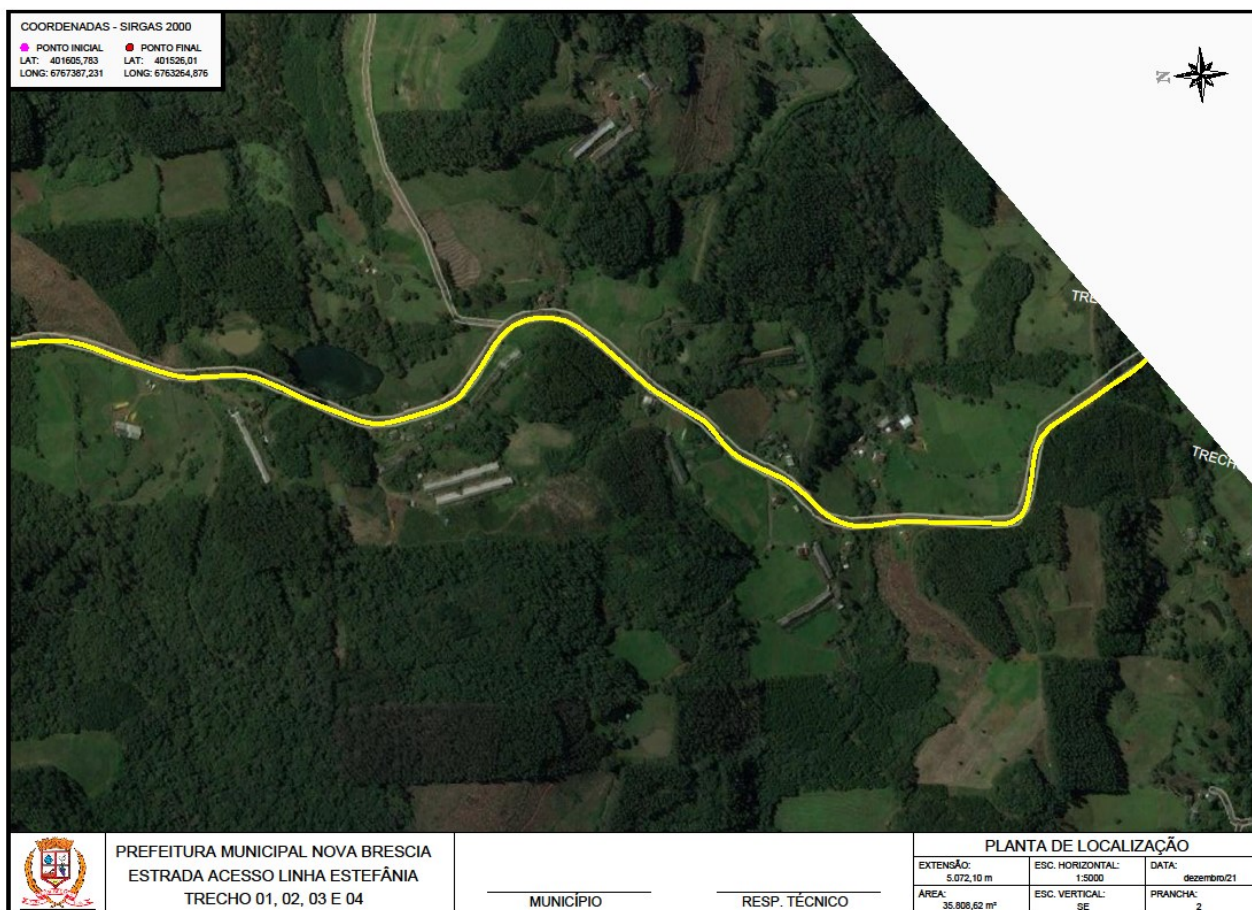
Planta de Situação Geral da Obra – trecho total até divisa Capitão
